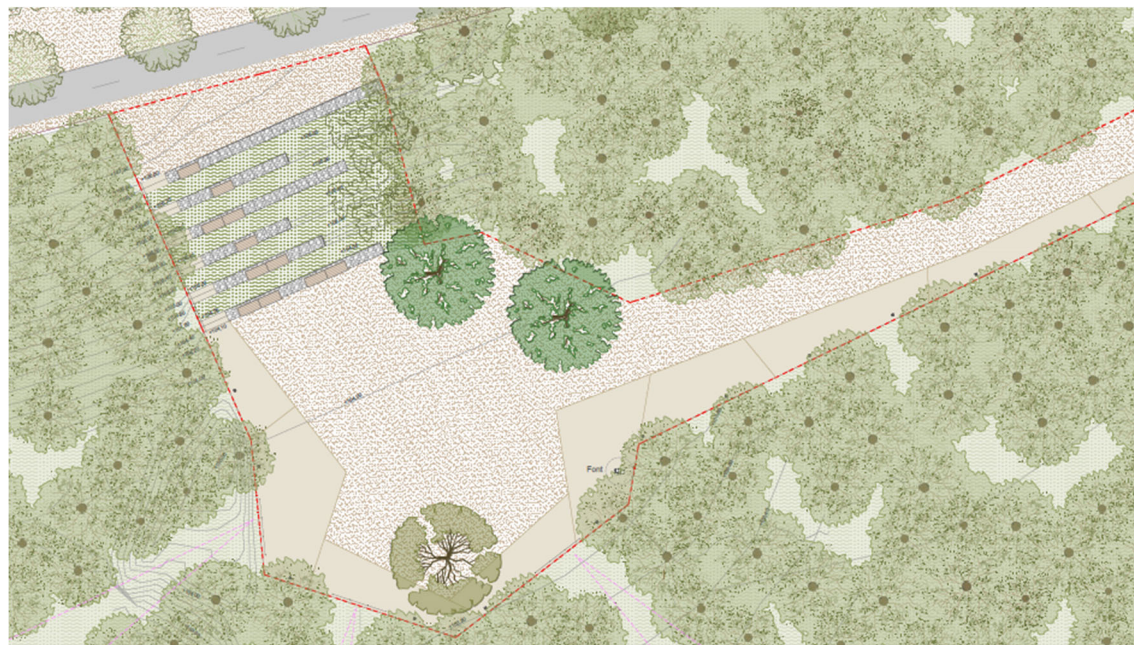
Planta proposta d'ordenació de la zona verda urbana al mirador
